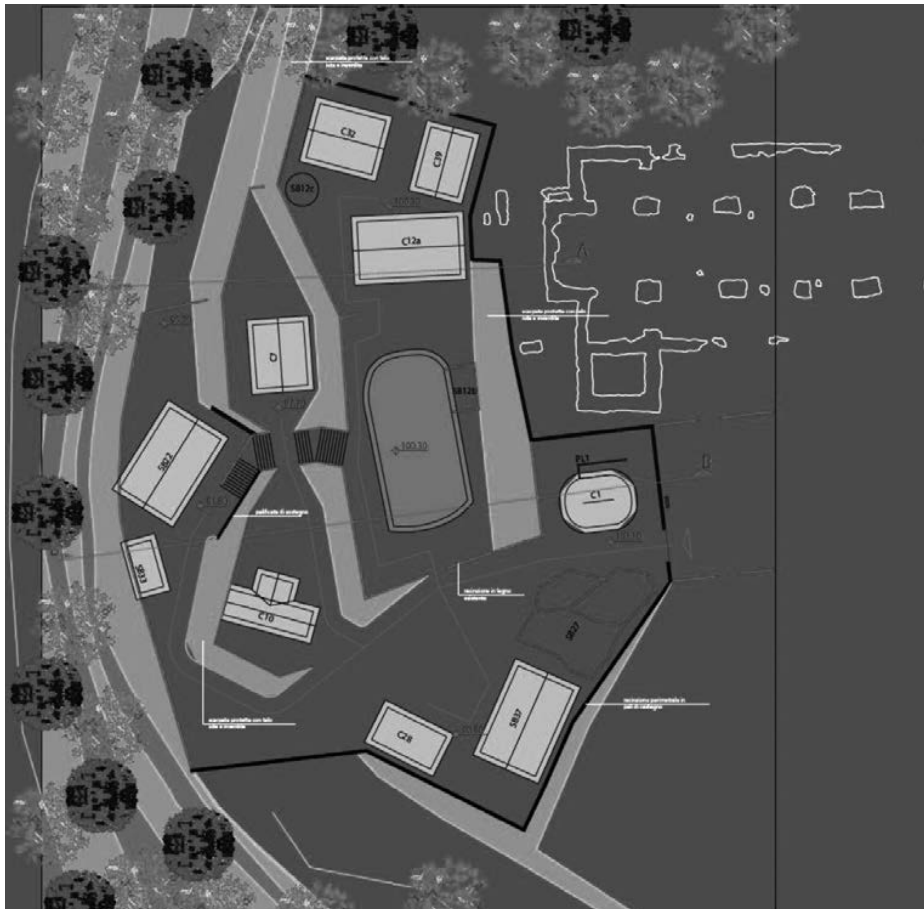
Pianta di lavoro con ipotesi impiegata durante la costruzione della longhouse.
